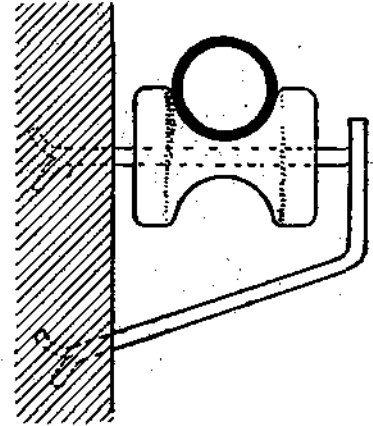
Прикрепление трансмиссий к железобетонным стойкам.
